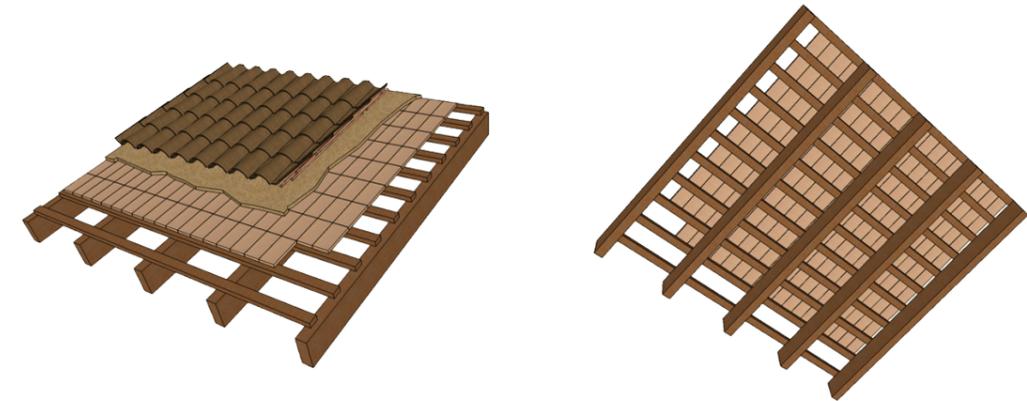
Vista cenital del entrevigado de la cubierta que cubre el Salón Comedor. Fuente: Propio autor.
